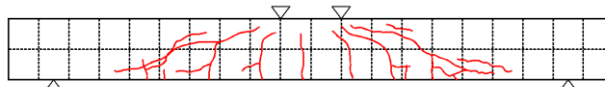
L-20 終局時ひび割れ図（76 万回）
